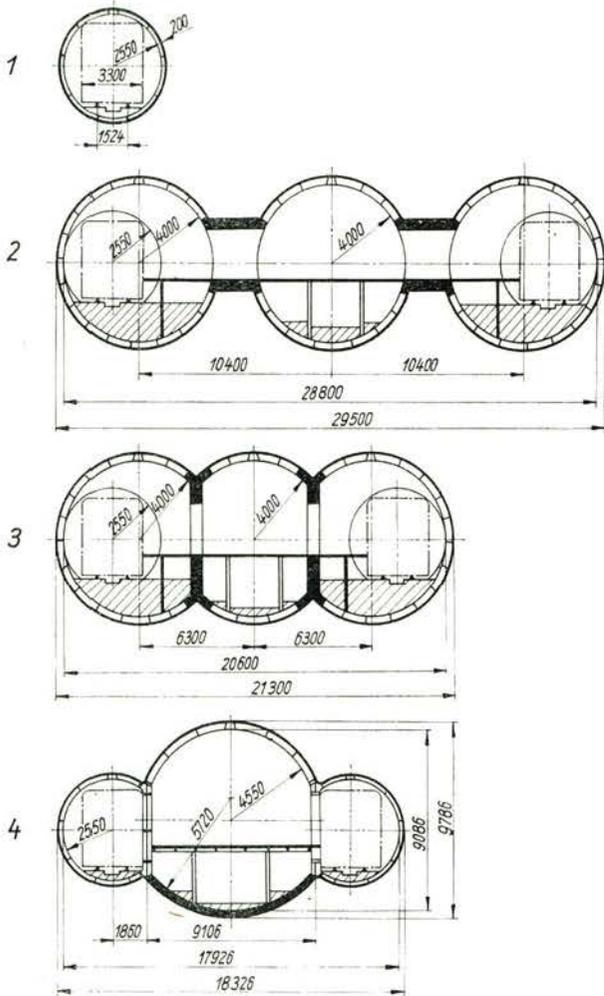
Querschnitte der Metro bei Bauweise in Tiefelage (Maßangaben sind Richtwerte). 1. freie Strecke mit Stahlbeton-Kassettenübbings, 2. Haltestelle mit Pylon-Säulen, 3. Haltestelle mit Kolonnen-Säulen, 4. Haltestelle mit türverschlossenem Bahnsteig
